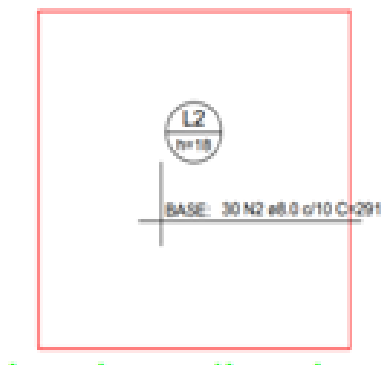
Armação superior do radier do pavimento possô elevador no eixo Y
